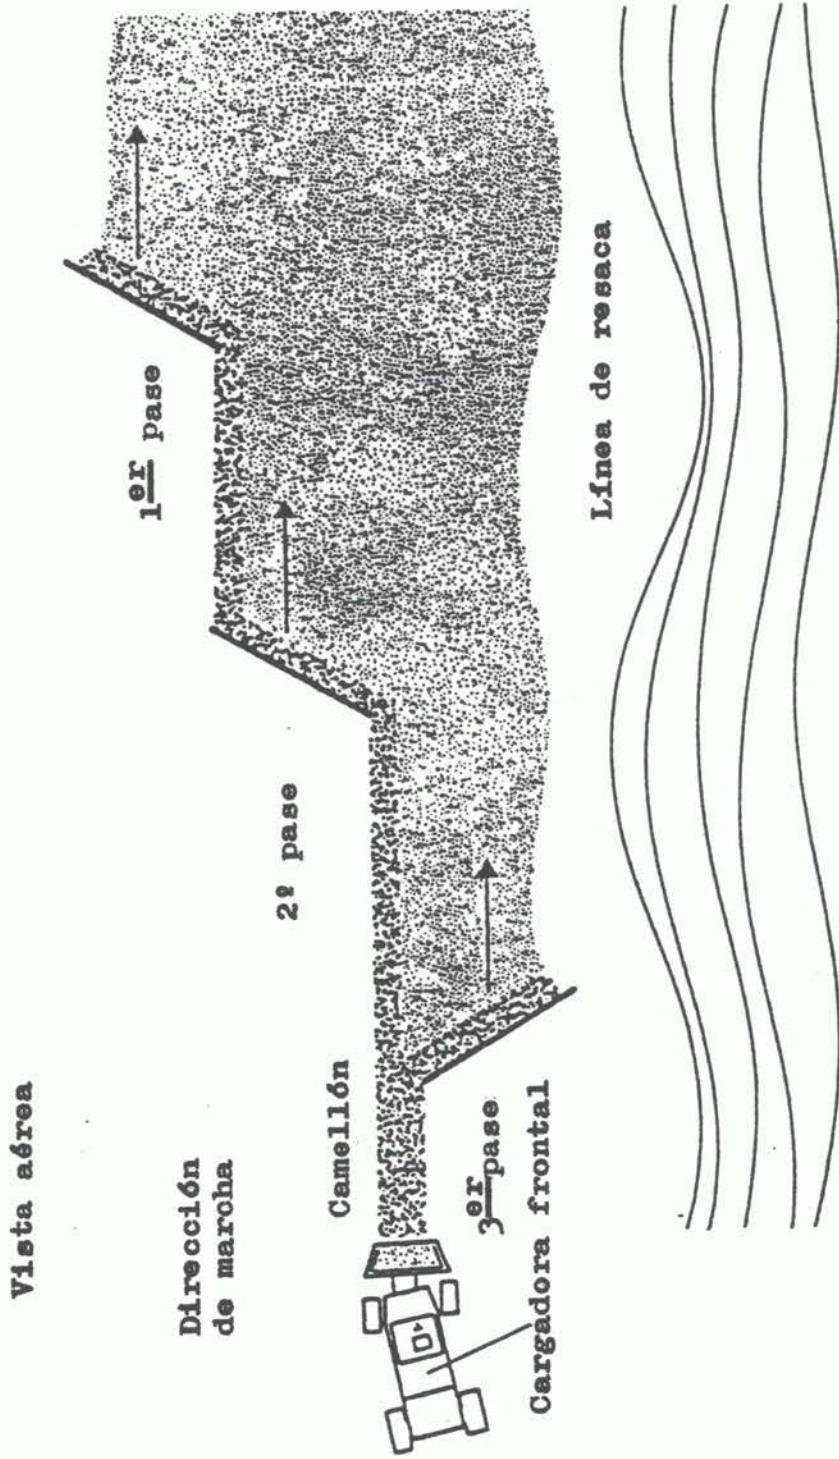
Sucesión de operaciones de una explanadora de motor y una cargadora frontal.
